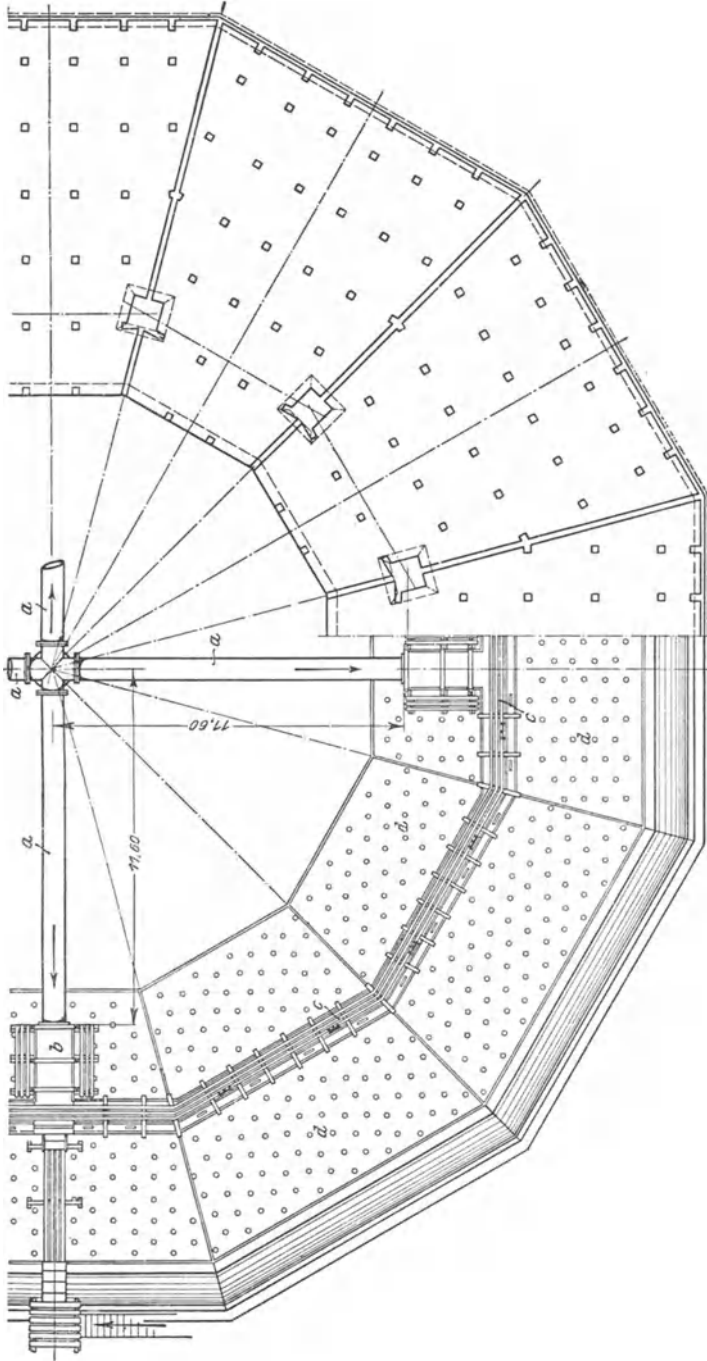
und 363. Querstrom-Kaminkühler der Maschinenbau A.-G. Balcke.
